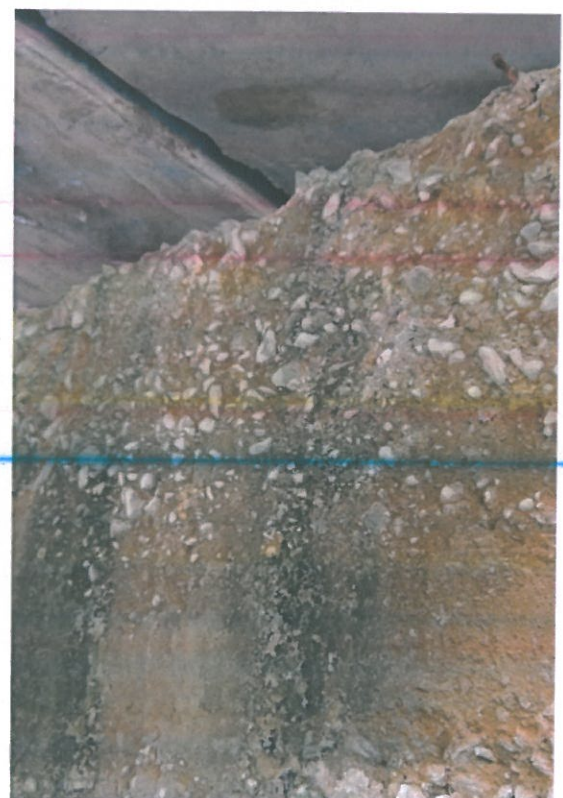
Pila este afuiata si subspalata pe partea dreapta
